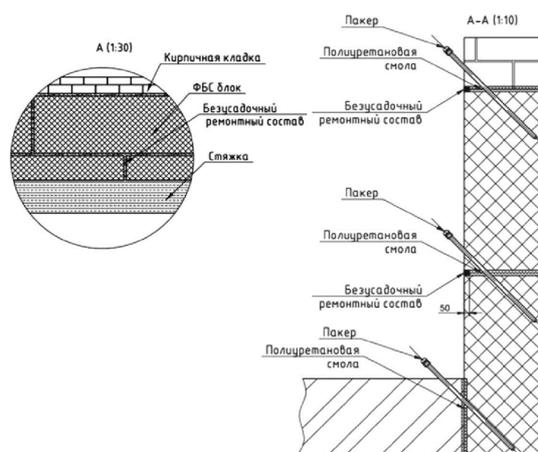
Схема гидроизоляции подвала из фундаментных блоков методом инъектирования полиуретановыми смолами
